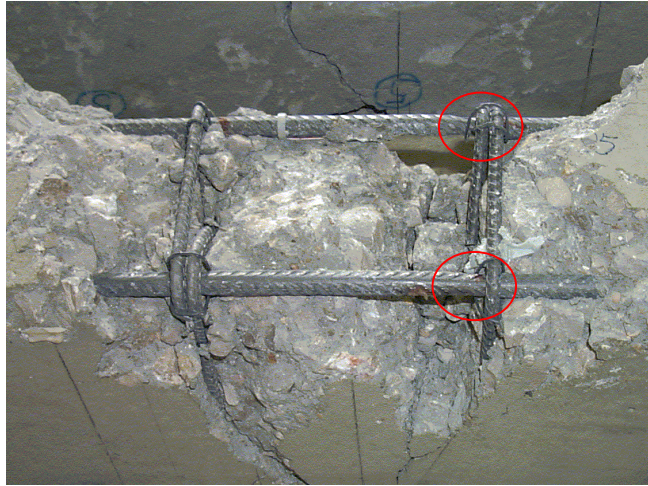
Striction des armatures tendues au niveau des fissures (vue de dessous)
